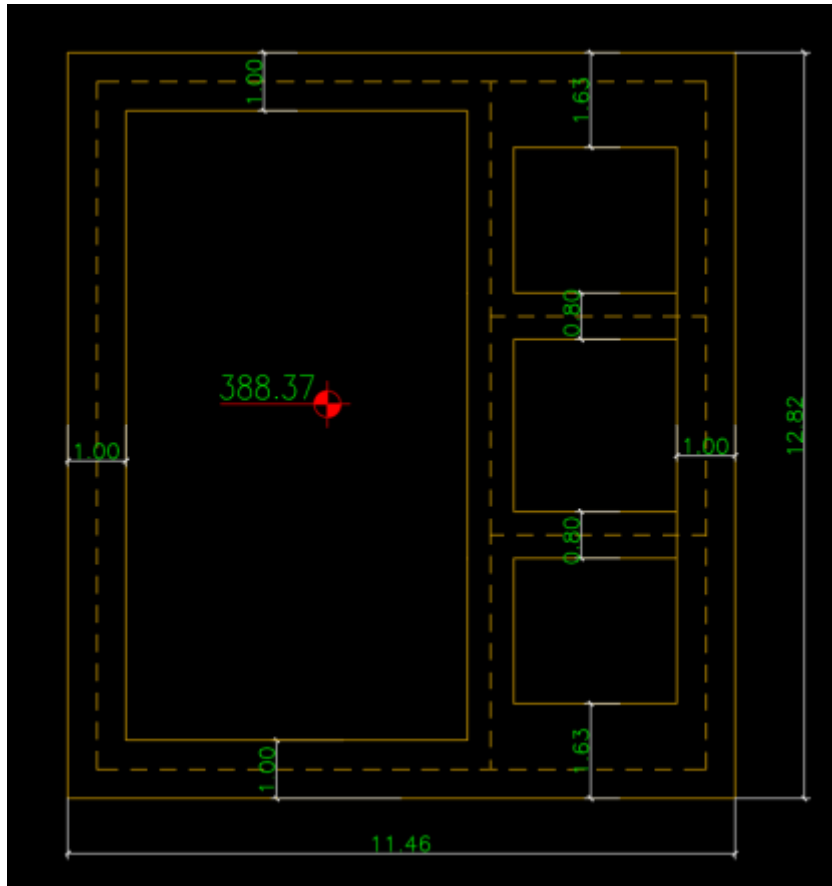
Piano di fondazione a quota 388.37m s.l.m.
